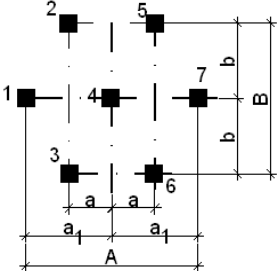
Схема к подбору фундаментов по таблице А.2
